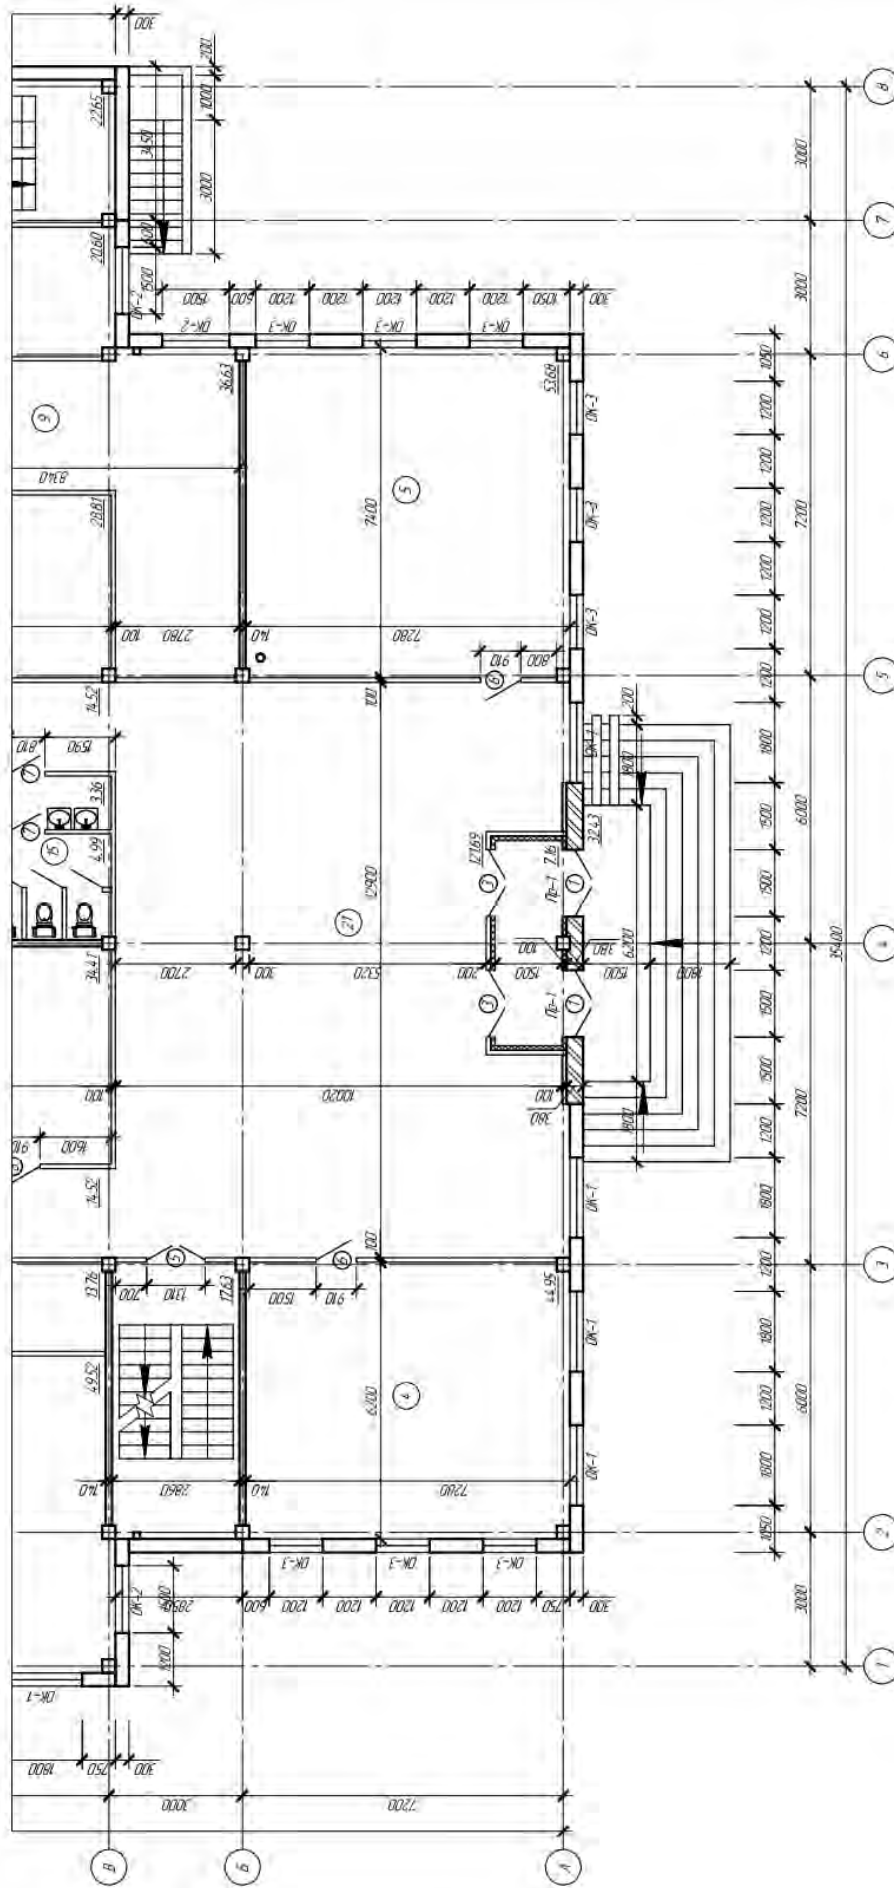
Пример выполнения фрагмента плана первого этажа
